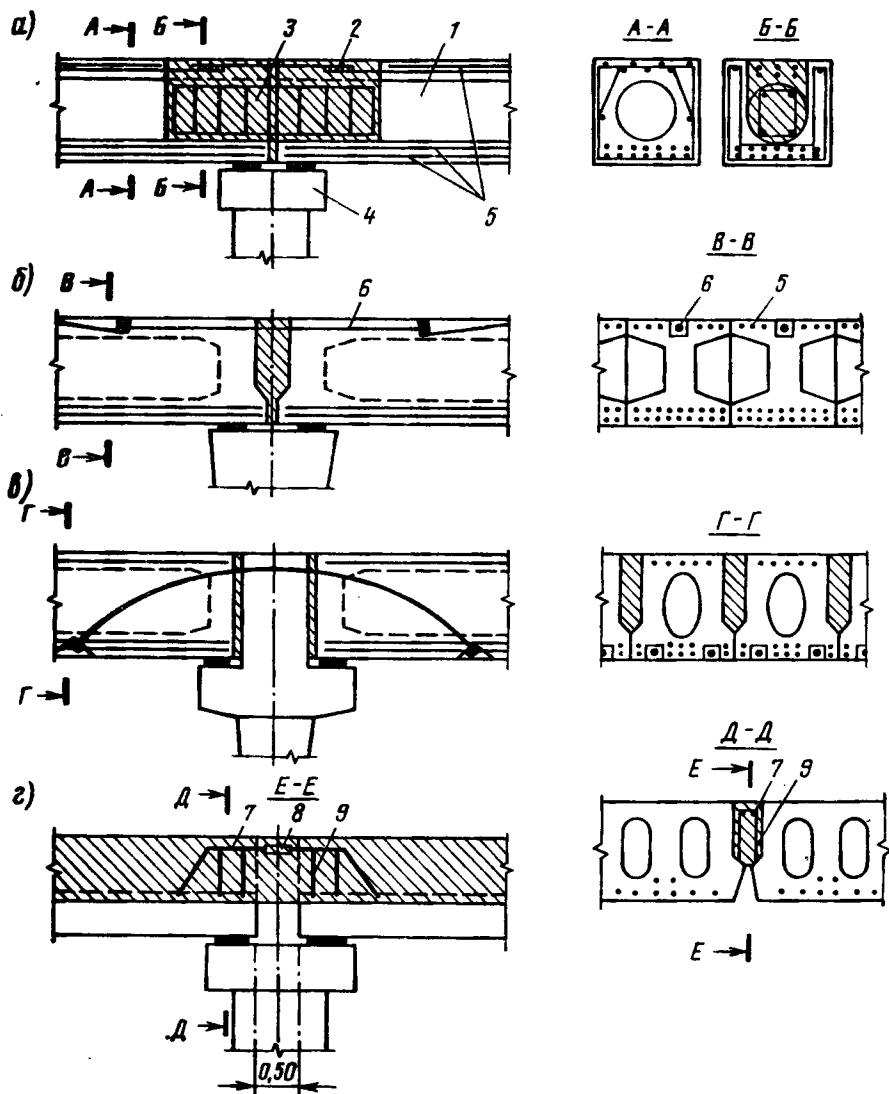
Конструкция надпорных стыков при образовании неразрезных и температурно-неразрезных плитных пролетных строений с напрягаемой арматурой: 1 — сборный элемент; 2 — сварной стык стержней арматуры; 3 — монолитный бетон; 4 — опора; 5 — напрягаемая до бетонирования арматура сборных элементов; 6 — арматура, напрягаемая до или после бетонирования надпорного стыка; 7 — рабочая арматура сопряжения; 8 — участки арматуры без зацепления с бетоном; 9 — хомут
